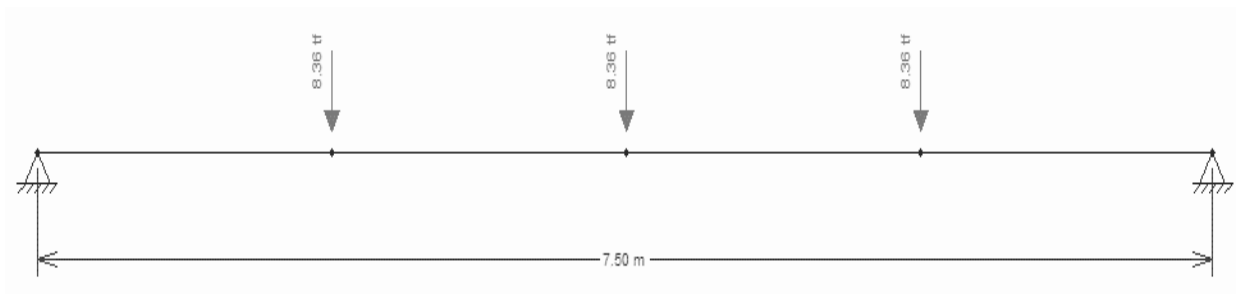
Viga de bordo submetida a cargas concentradas
